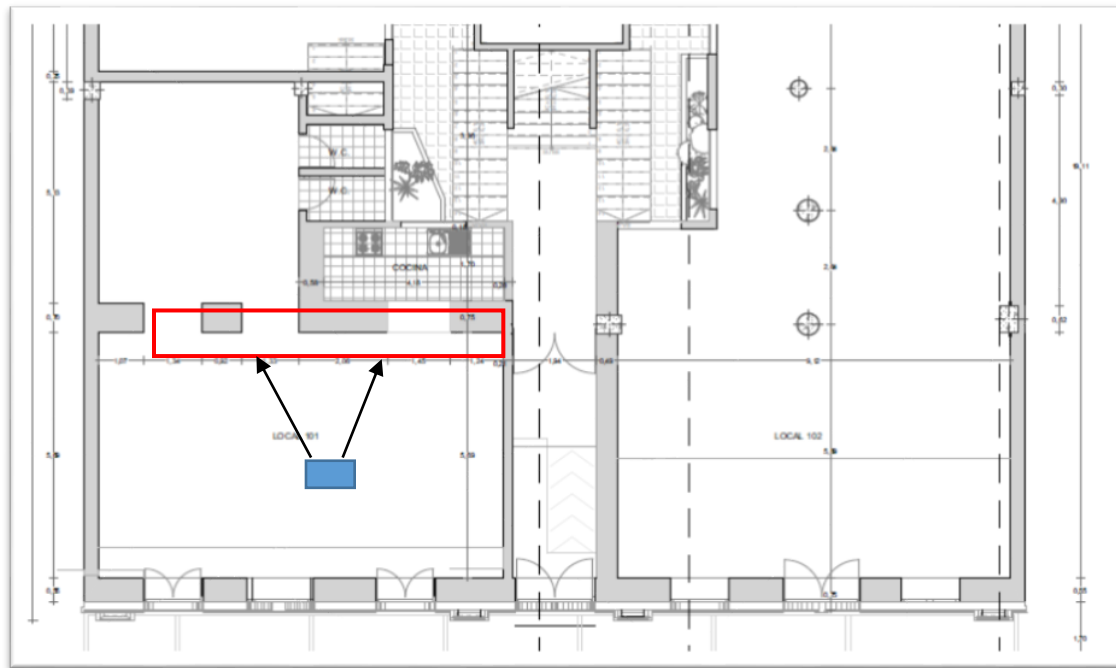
Detalle de fachada y entrepiso en madera. Sector a restaurar. Fuente propia
